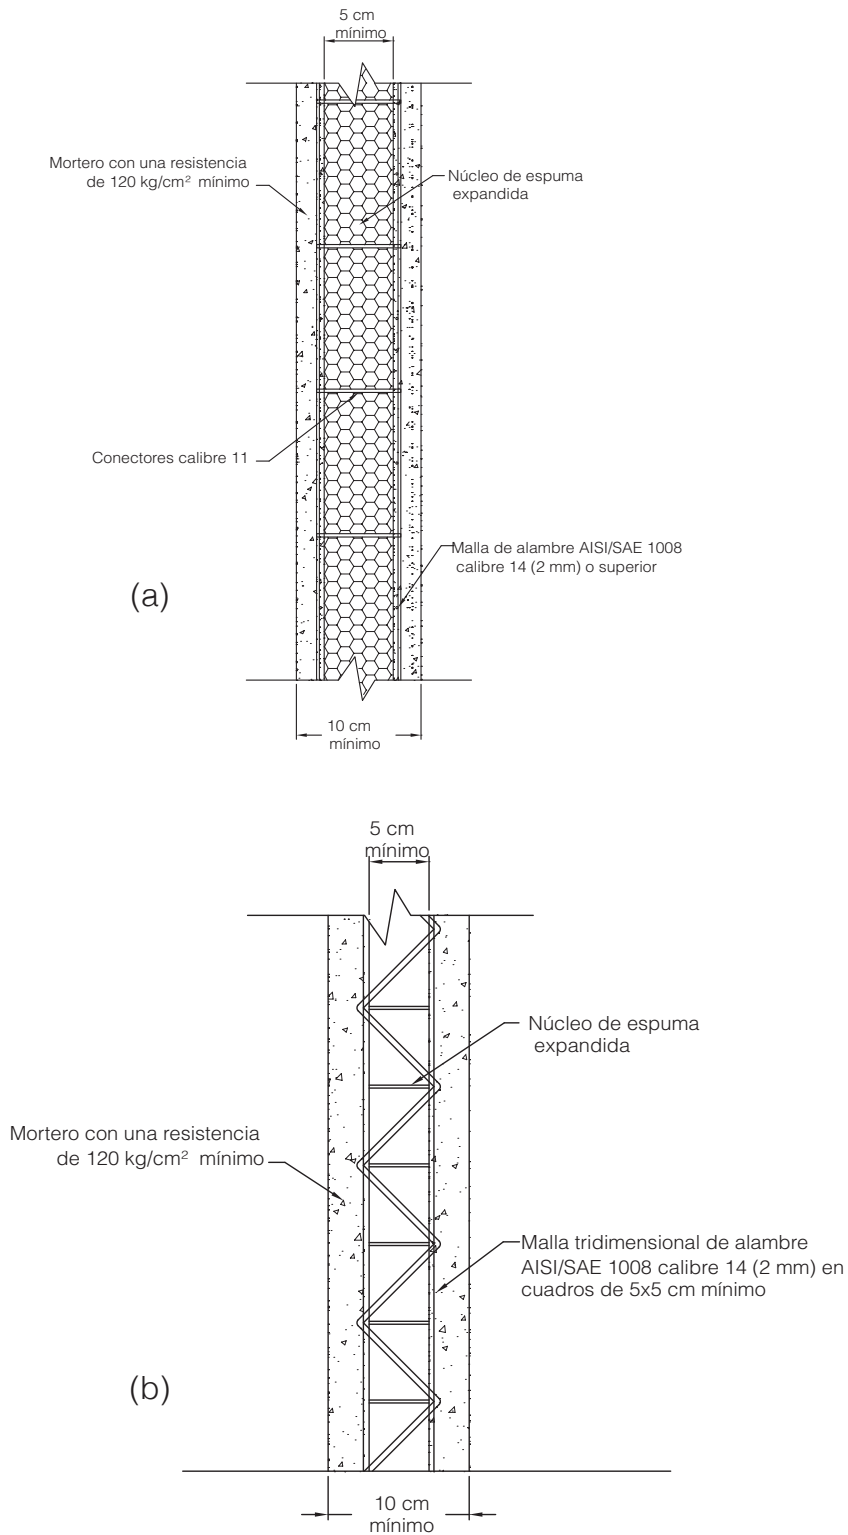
Detalles de posibles paredes tipo emparedado.
